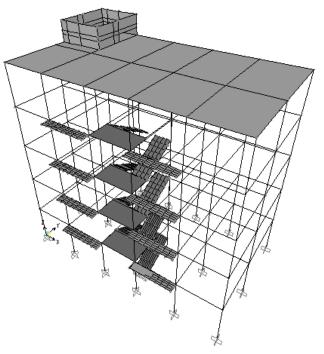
MODELISATION DE LA STRUCTURE AVEC RESERVOIR (POSITION 2)
